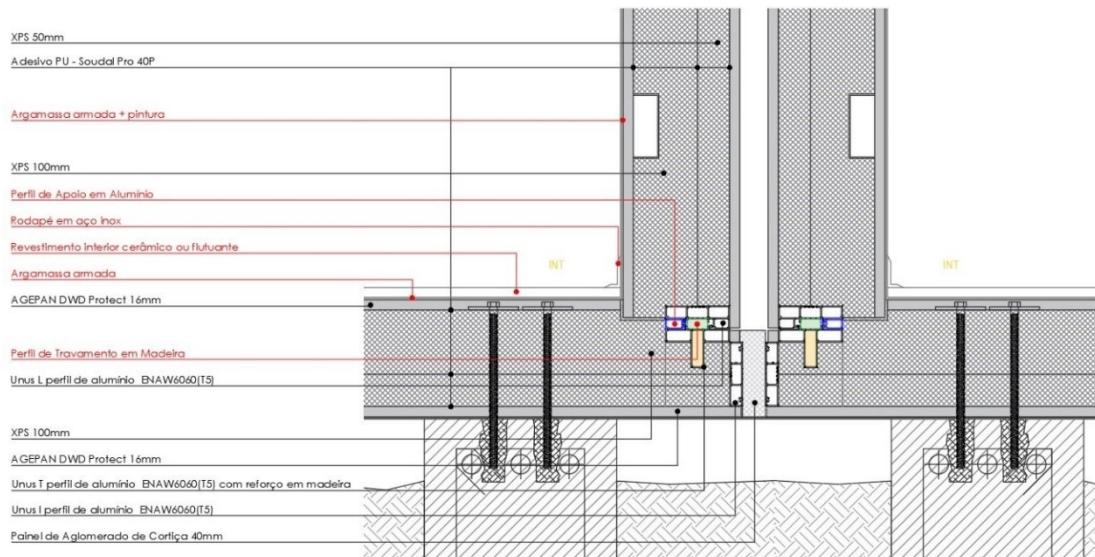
Solução Final – Pormenor construtivo de parede interior/piso de duas frações independentes.
